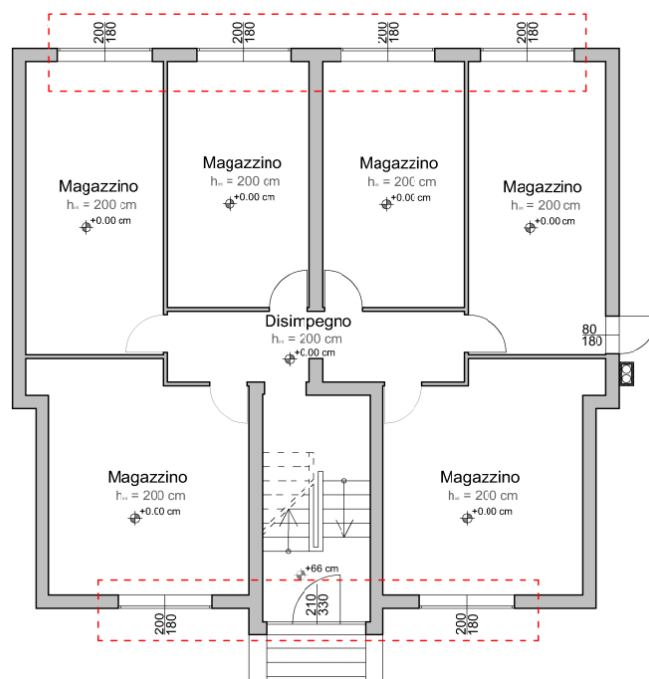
Vulnerabilità in pianta: in rosso, riduzione della sezione muraria del prospetto est ed ovest.
